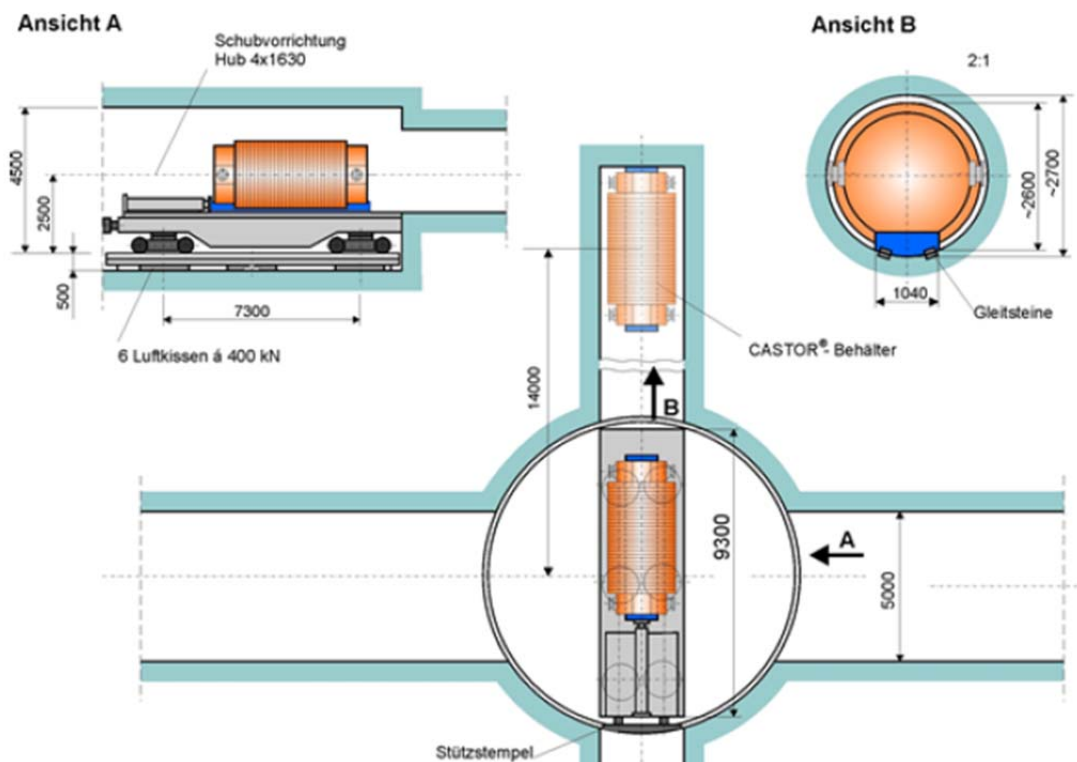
Einlagerungsschema mit Draufsicht des Einlagerungsortes innerhalb der Beschickungstrecke für die TLB-Einlagerung mit Längs- und Querschnitt im horizontalen Einlagerungsbohrloch /GRS 12/
